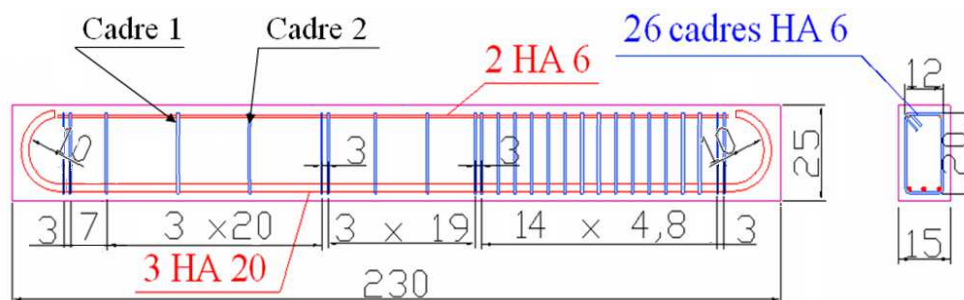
Plan de ferrailage des poutres sous dimensionnées à l'effort tranchant
